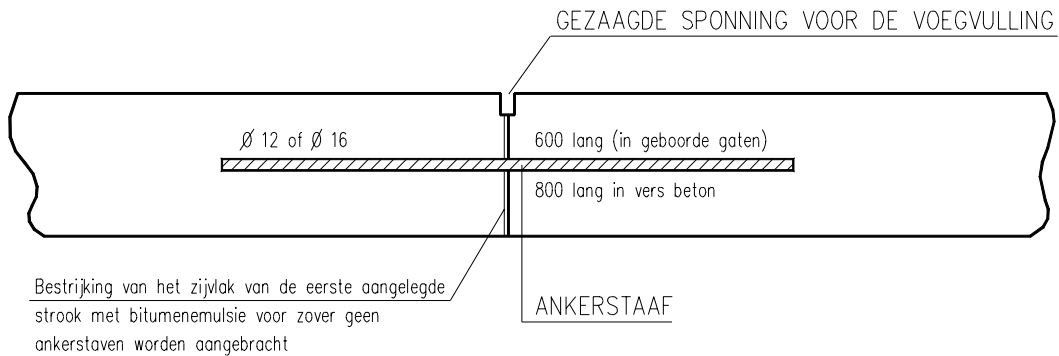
detail van de langse buigingsvoeg (alle maten in mm)
